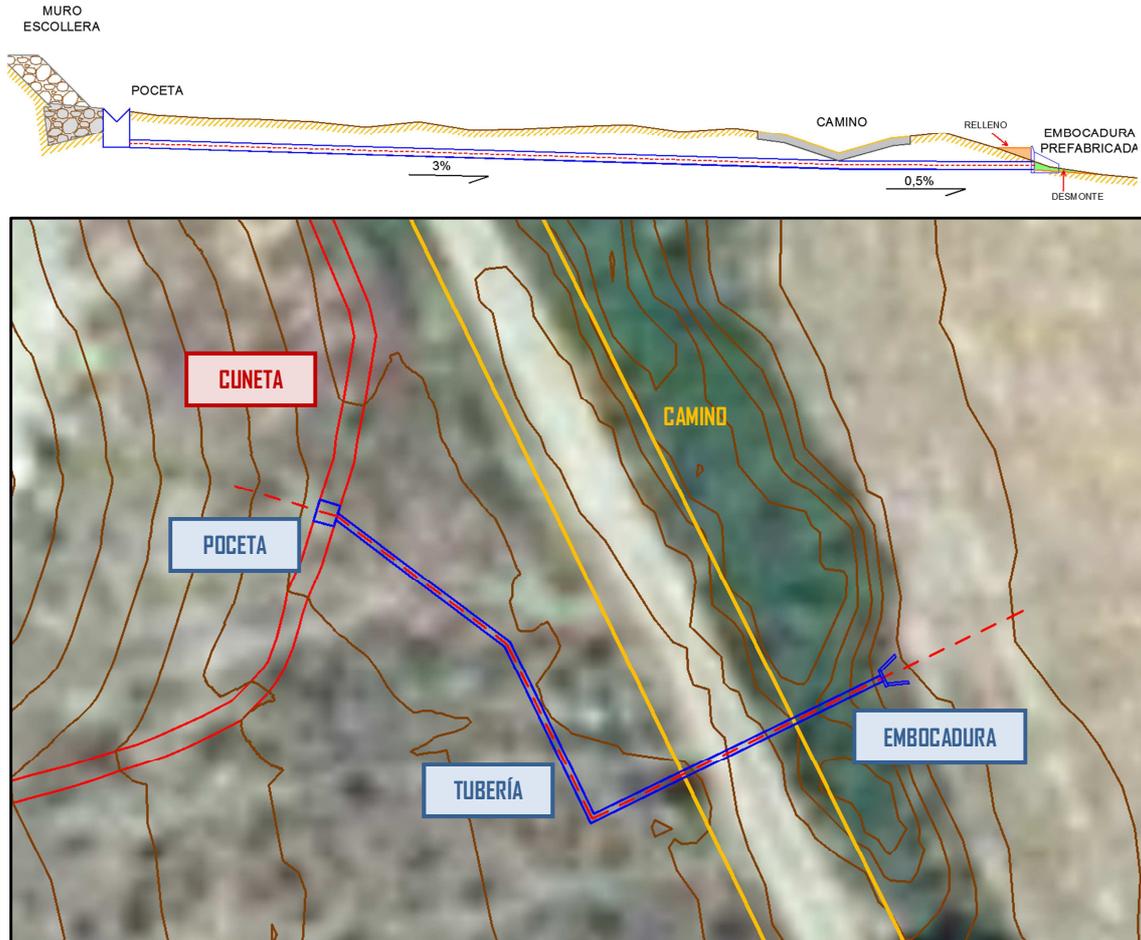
Sistema de evacuación de las aguas (alzado y planta).
